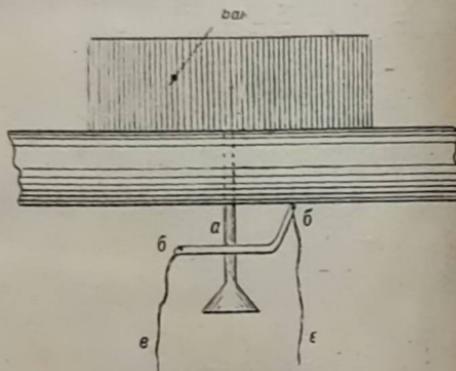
Схема водоснабжения убежища водопроводной сетью.
